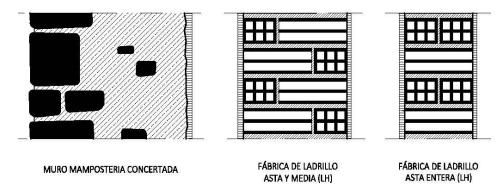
Tipos de fachada portante habitualmente empleados en la construcción de viviendas protegidas
